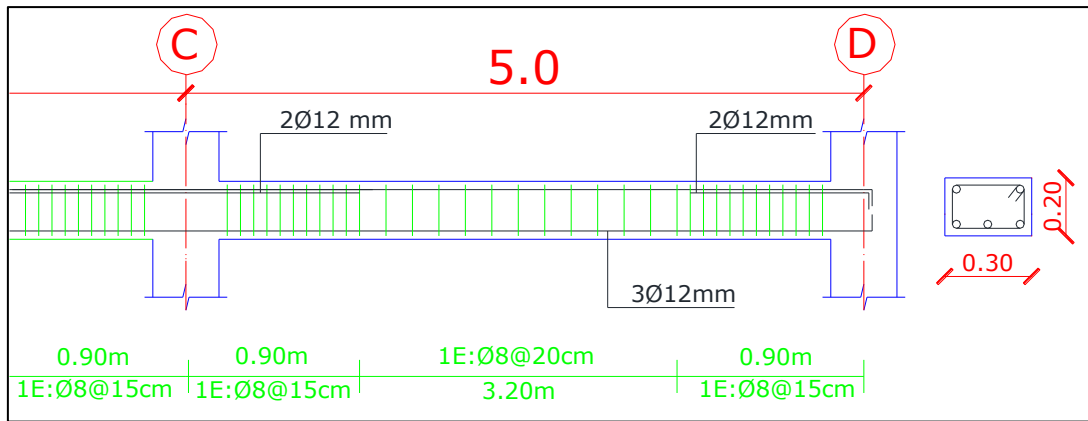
Detalle de viga, vano CD, piso 1y2, Pórtico 2.
